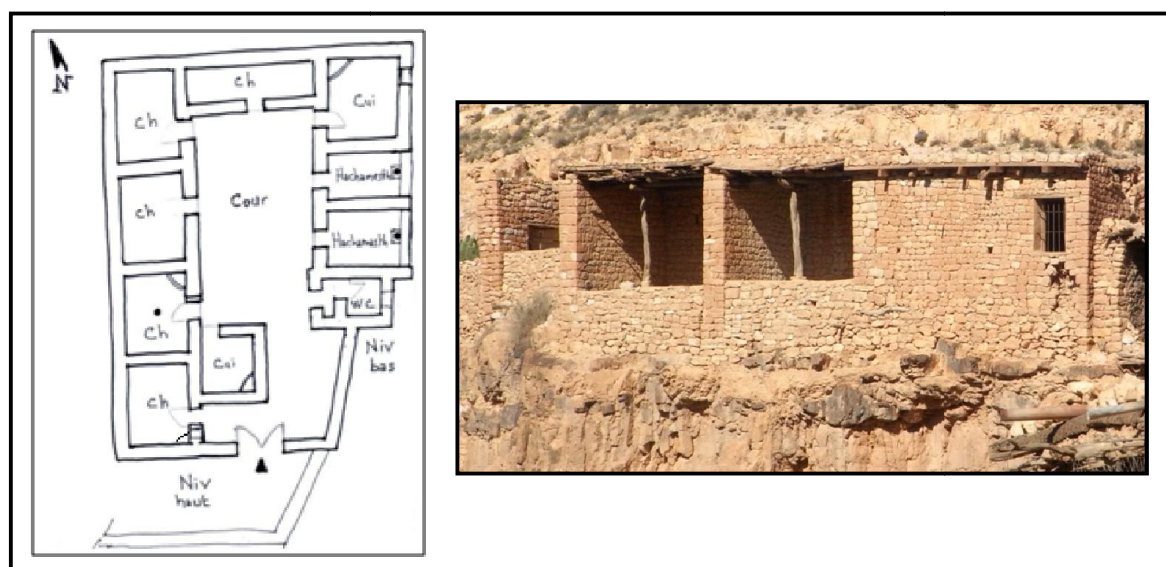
, 3.14: Plan et photo de la maison traditionnelle de la famille Bekhouche à Haourireth
